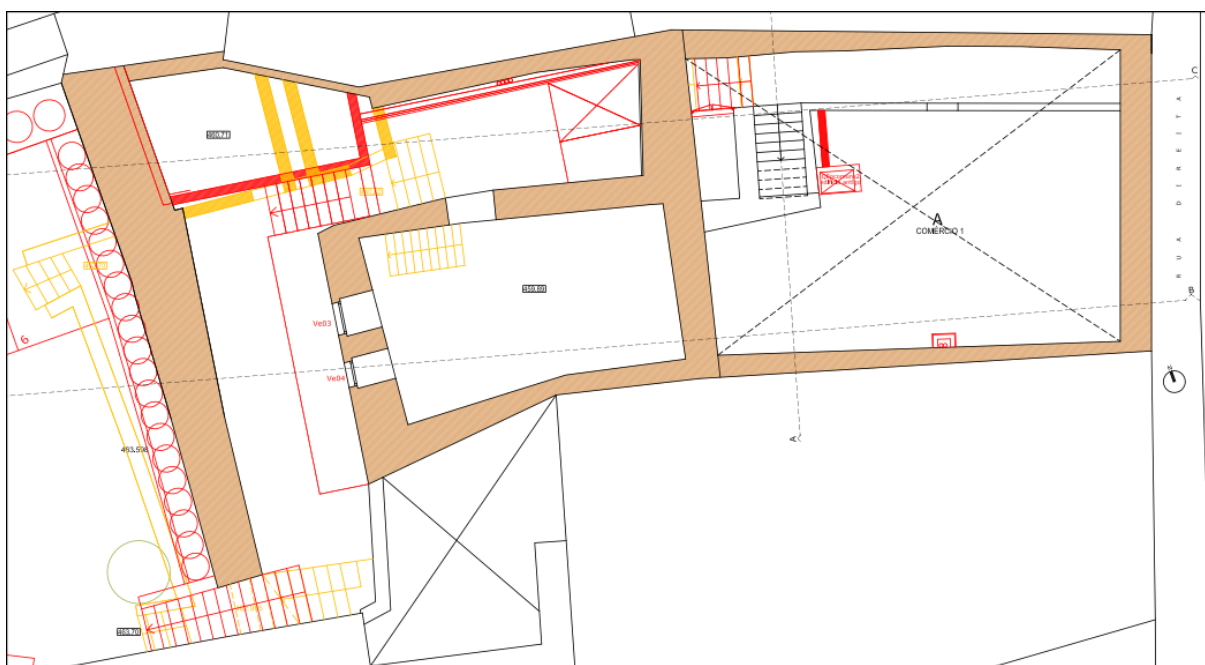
Planta do Piso 1/2 do edifício 2 em estudo
